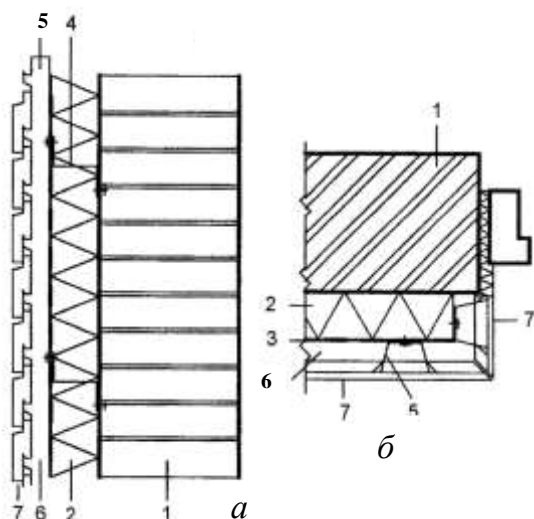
Цегляна стіна з навісною фасадною системою теплоізоляції та вентиляльованим повітряним прошарком і опорядженням індустріальними елементами (клас В):
